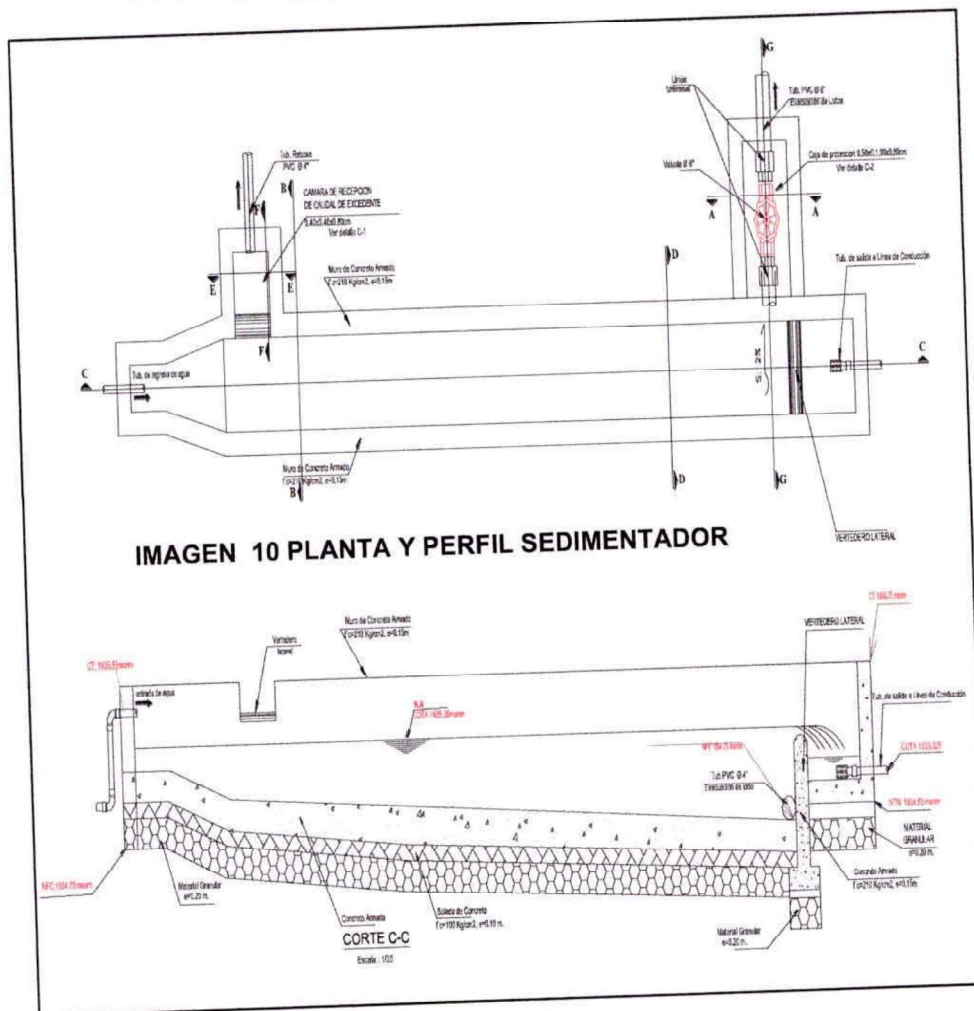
PLANTA Y PERFIL SEDIMENTADOR
